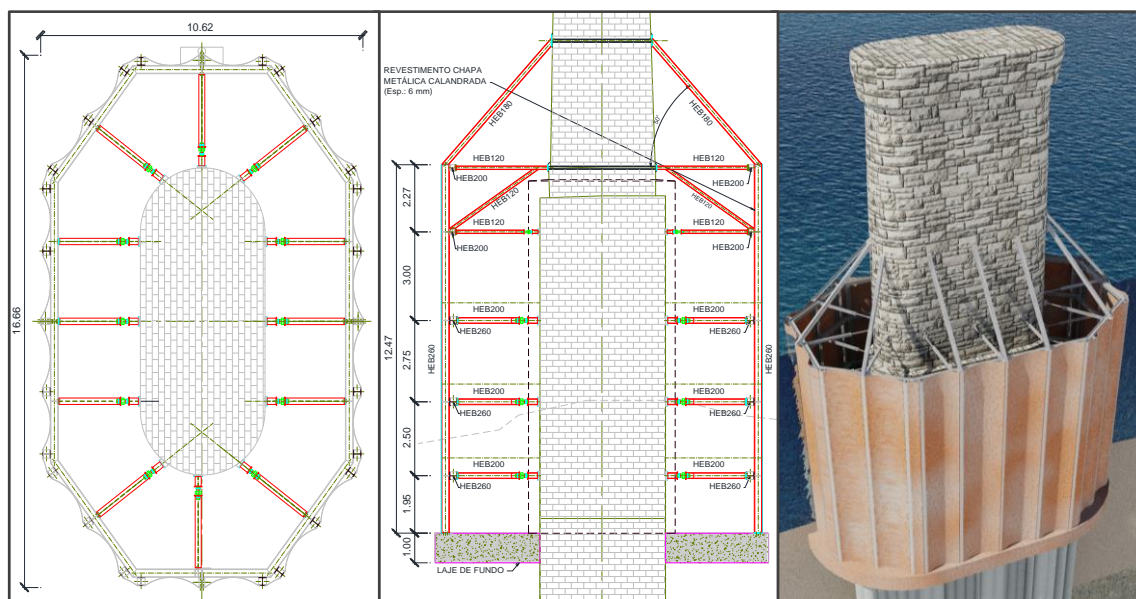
Planta, corte esquemático e perspectiva da estrutura da ensecadeira da Ponte de Valença em torno do pilar
